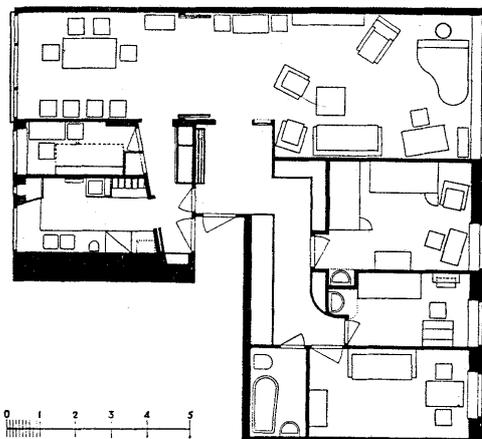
Harald Bergsten: Grundriss der Mietwohnung 14.
